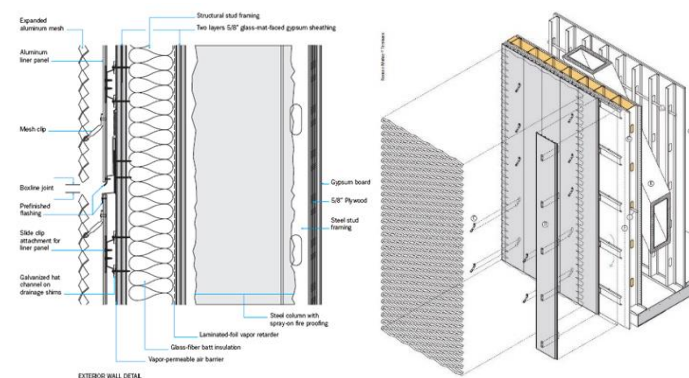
Detalle constructivo de la fachada. (Brooks, 2010; Varela, 2017)
